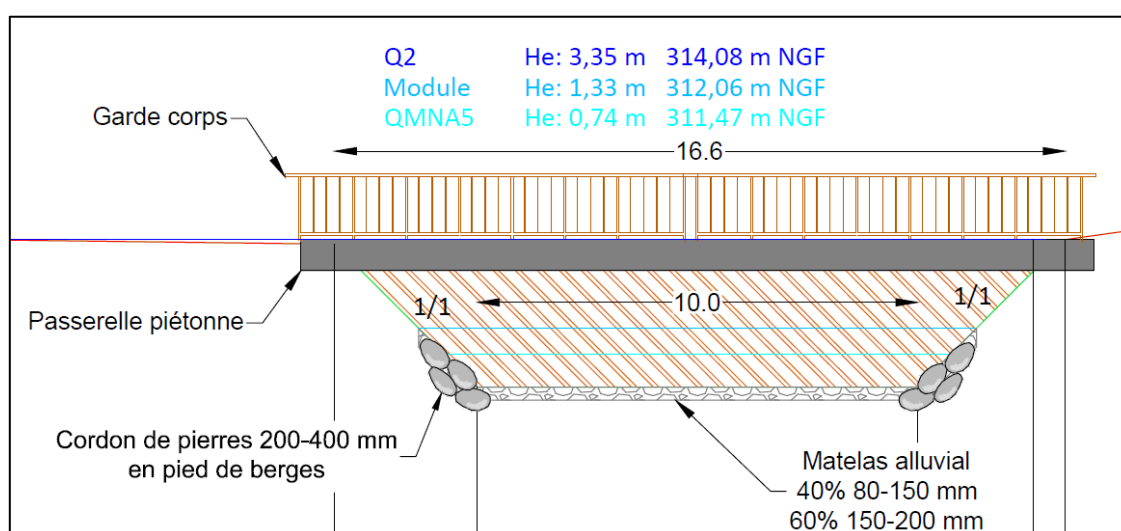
Profil en travers de la passerelle sur le bras de contournement (PT147)
